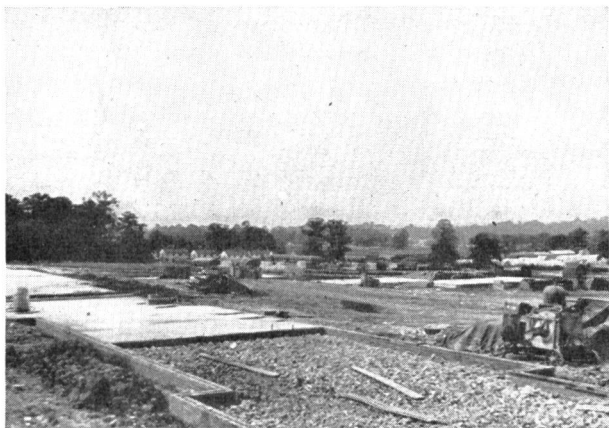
Siedlung für Ausgebombte. Der Trümmerschutt wird verschrottet, in ein schnell erstelltes Fundament geschüttet, darüber eine Betondecke gelegt und darauf die Häuser errichtet.
